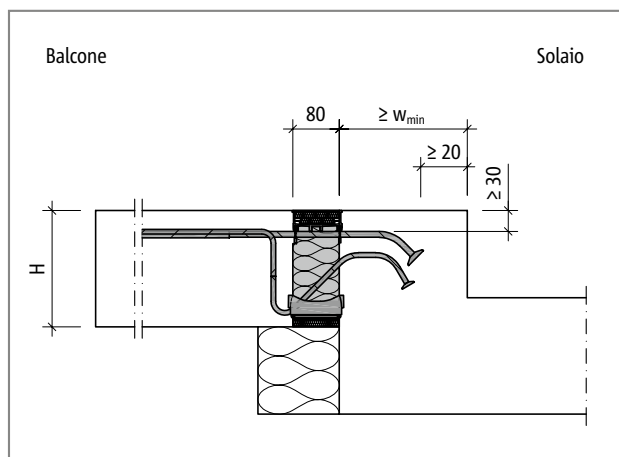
Schöck Isokorb® T tipo KL-O: balcone con dislivello verso l'alto ed isolamento esterno
